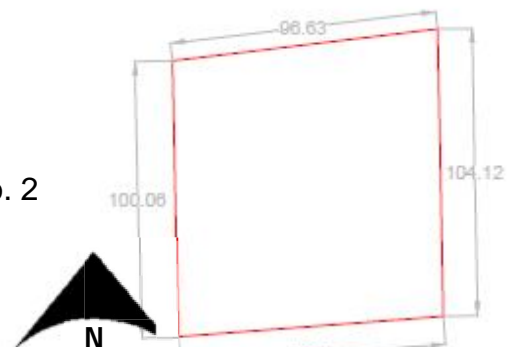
Plano de terreno 3. Fuente Propia s/e. Cotas en m.
